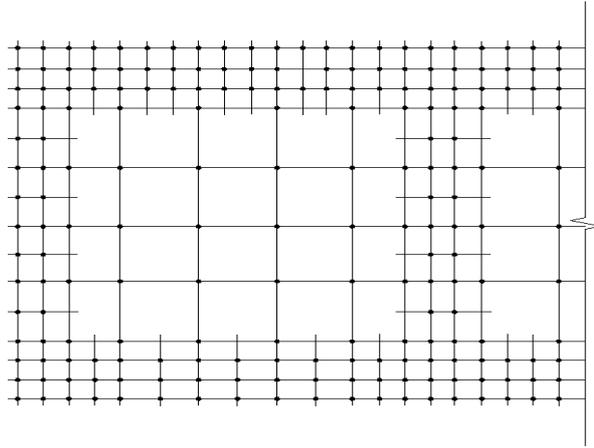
模板支撑架不同立杆间距布置平面示意图
